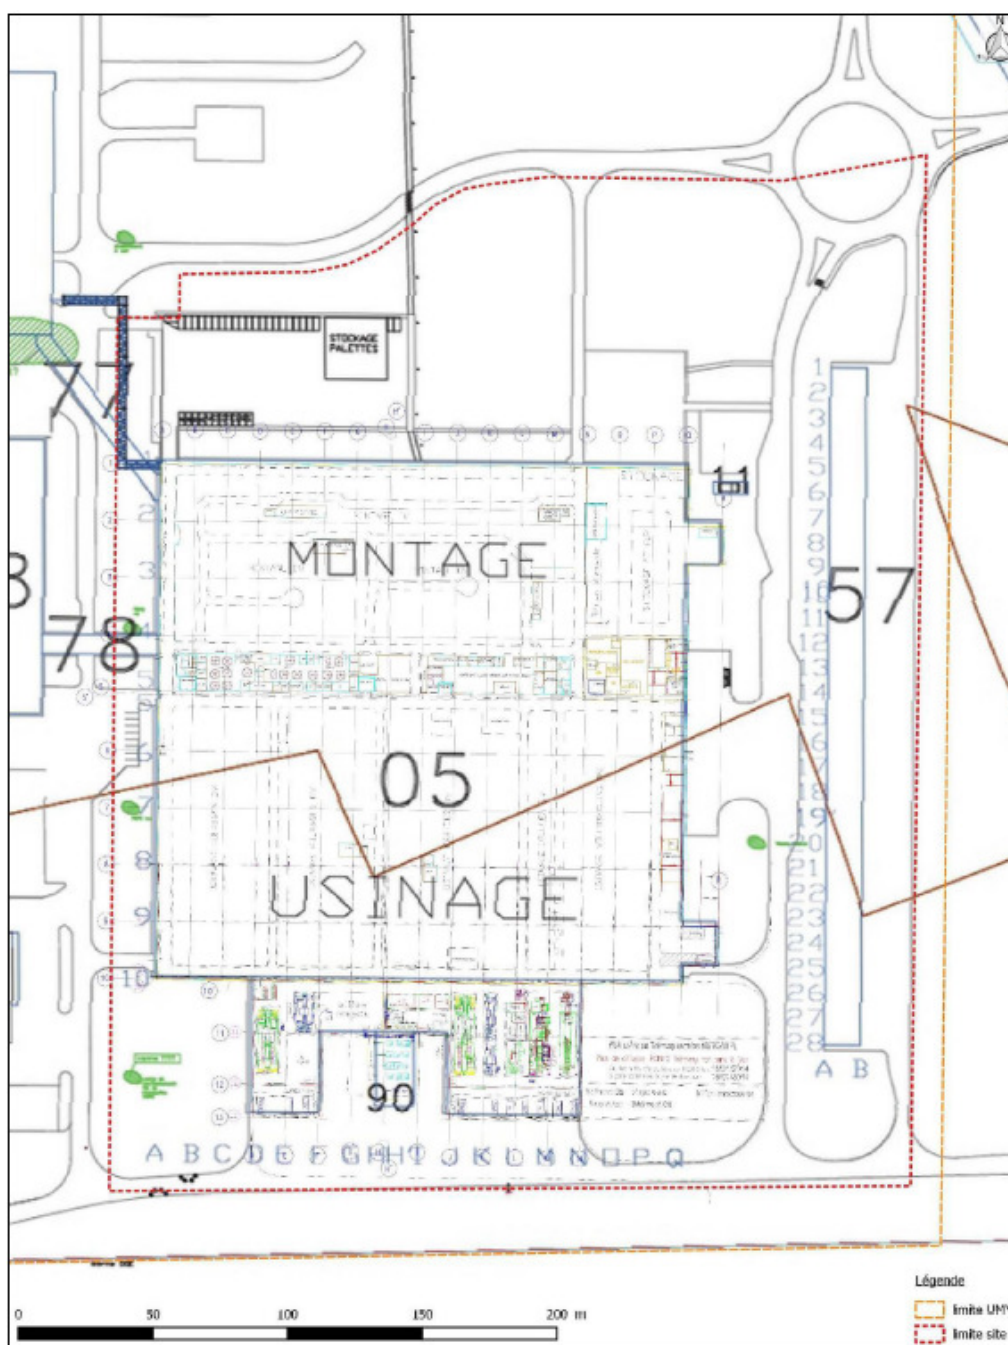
plan de masse de la zone d'étude (Source : rapport DEKRA 52660020)
